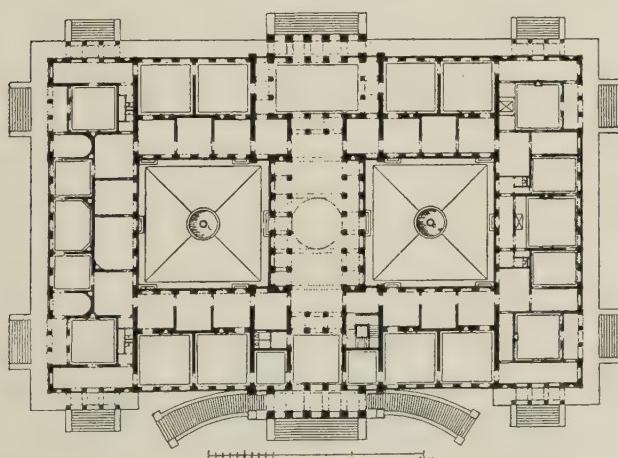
Schloß Rosenstein bei Stuttgart Grundriss
